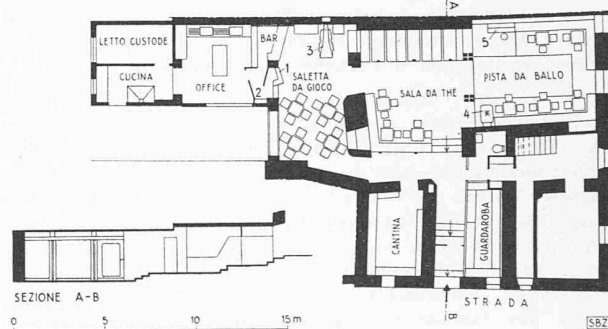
Tavernetta «Shangri-là» in Bormio. Grundriss 1:400. 1 Kasse, 2 Telephon, 3 Kaminofen, 4 Ofen, 5 Klavier
